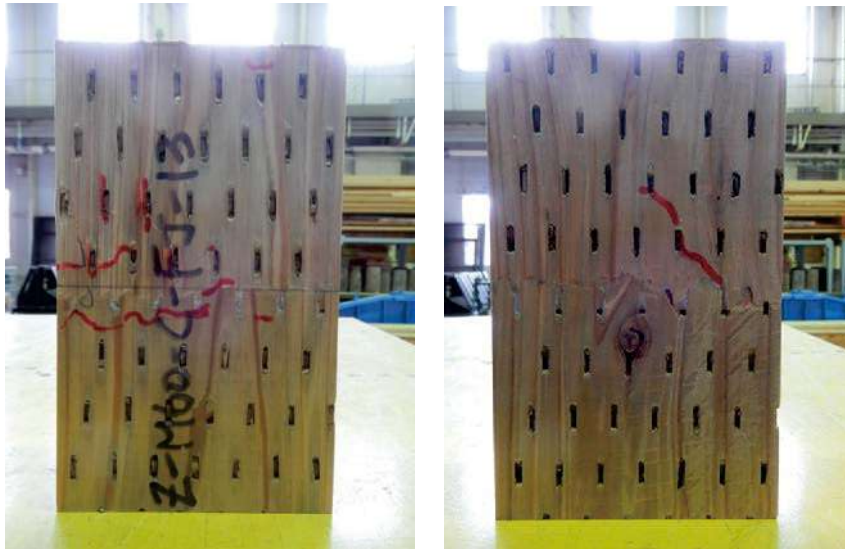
AAC 処理 M60 の破壊形態の例 写真 2.3.8.3-8 AAC 処理 M30 の破壊形態の例
